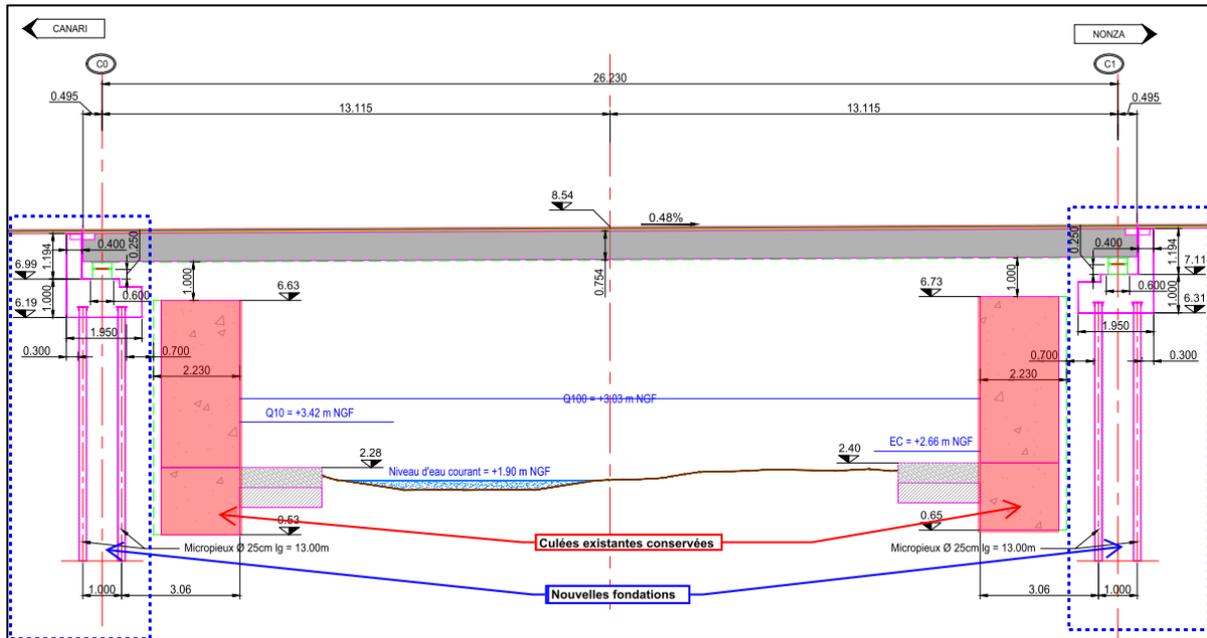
Etat projeté Solution Poutrelle enrobée - Coupe longitudinale (source : Collectivité de Corse)
